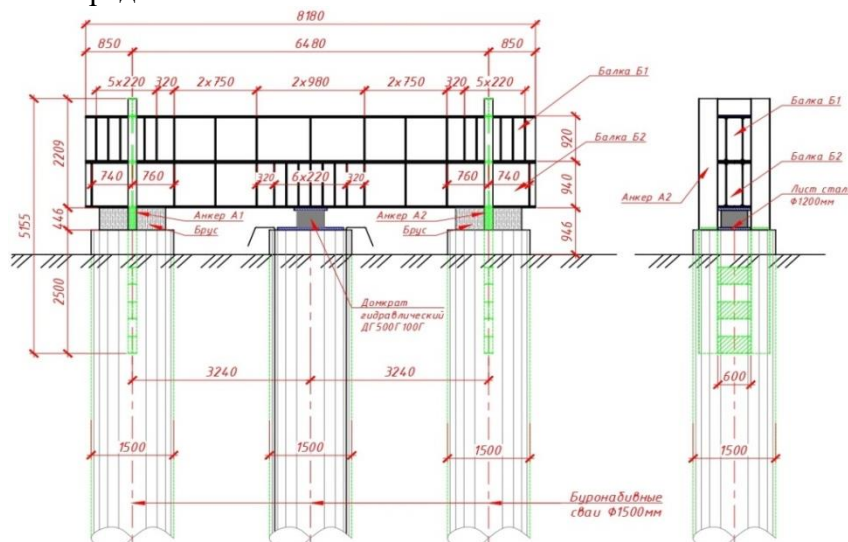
Схема проведения натурных испытаний буронабивных свай
